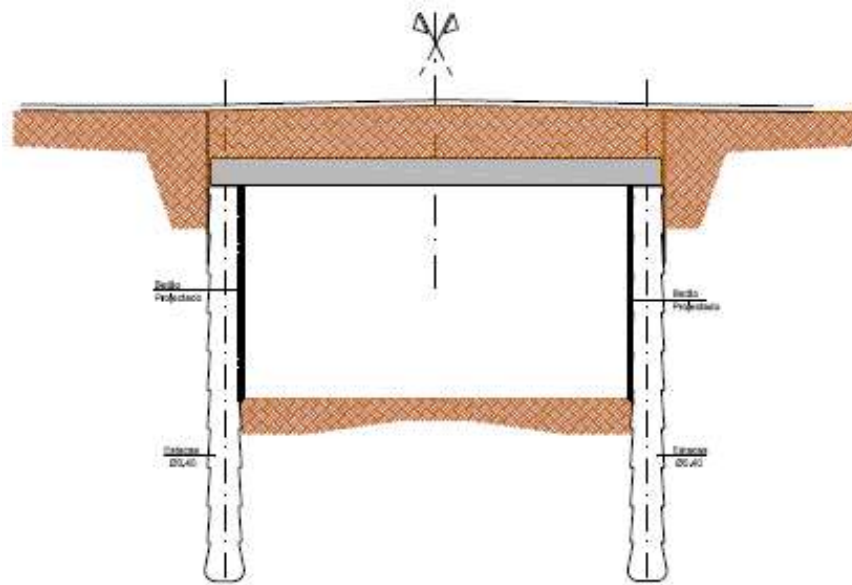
Fase 6 - Escavação sob a laje de topo. Execução do de betão projetado ao longo da cortina de estacas.
